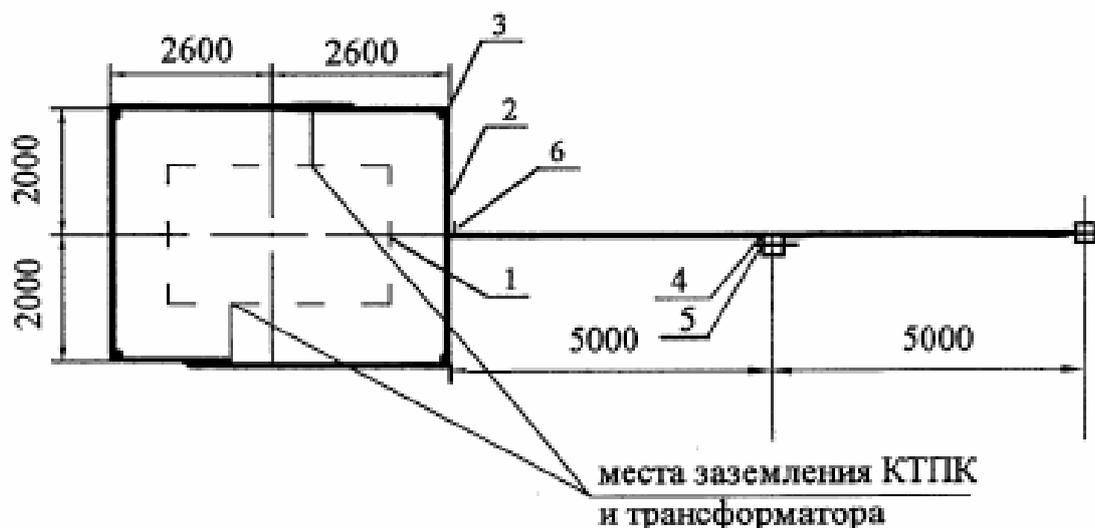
План расположения заземляющего устройства КТПК 10/0,4 кВ киоскового типа с воздушным вводом и кабельным выводом: 1 – периметр каркаса подстанции; 2- горизонтальный заземлитель; 3 – вертикальный заземлитель; 4 – заземляющий проводник; 5 – стойка концевой опоры ВЛ 10 кВ с разъединителем; 6 – место сварки (в местах стыковки каркаса КТПК, вводного короба и кронштейна)
